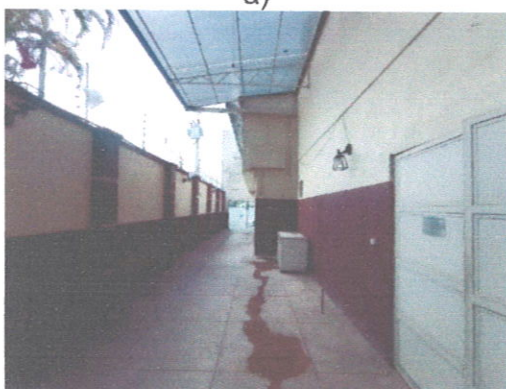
Cacau show eventos – Pavimento térreo – Avenida Américo Lopes, 114 – São Miguel do Guamá – PA.
